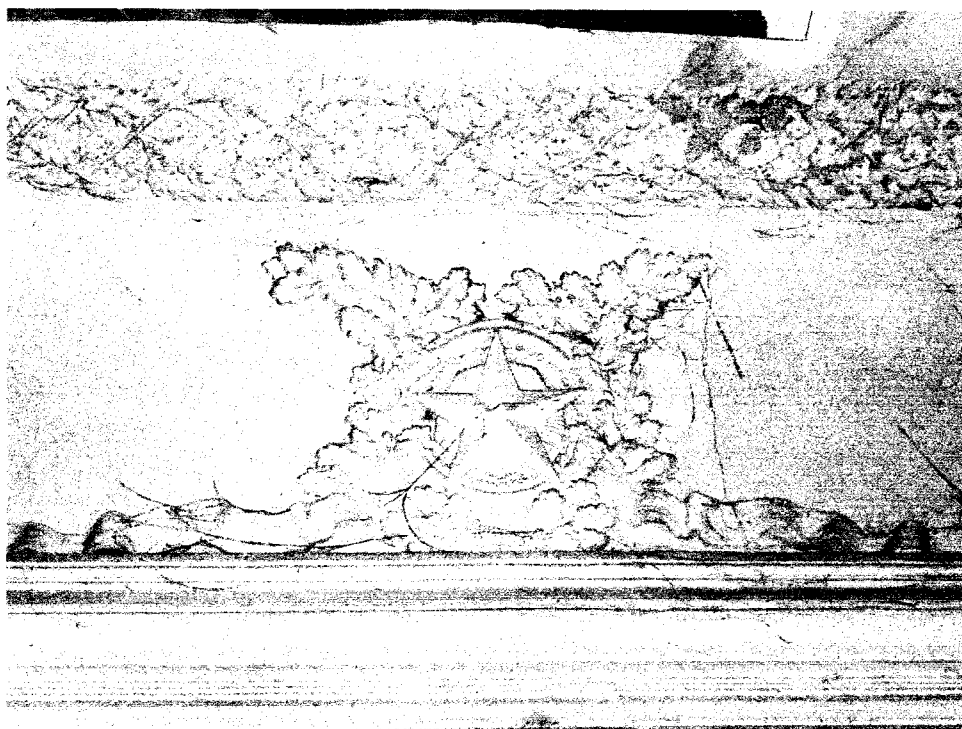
Второй этаж. Помещение 21. Большой зал. Лепной элемент
